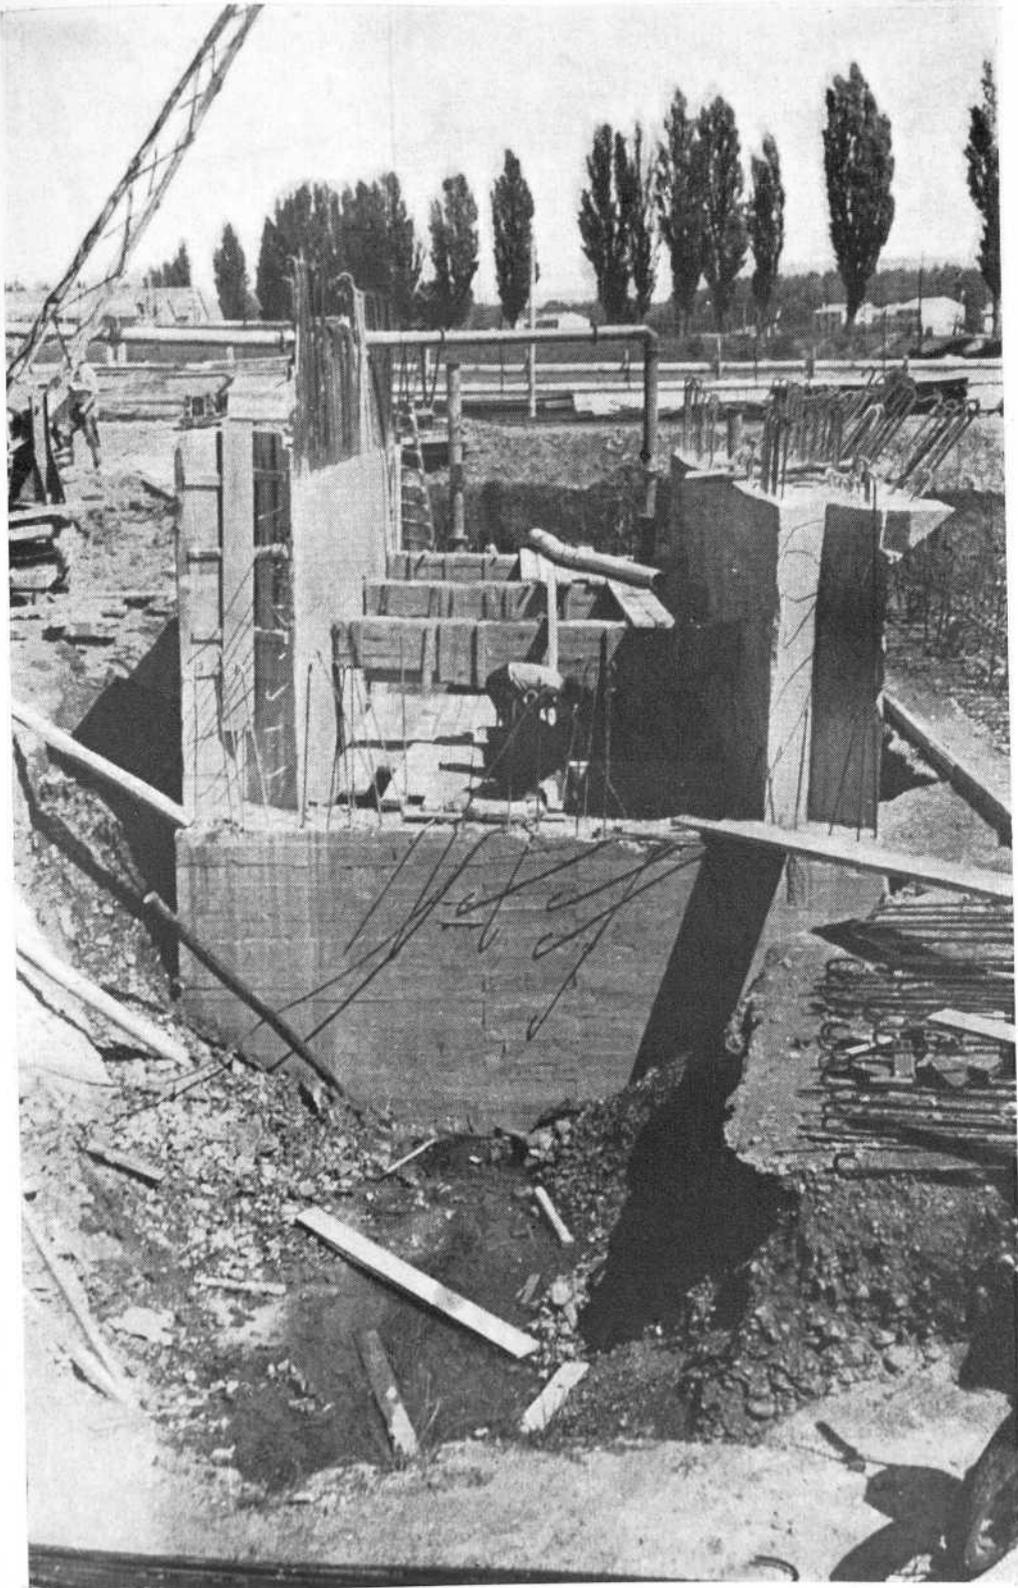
Cimentación del Silo de Burgos. Vista lateral del cajón indio.
